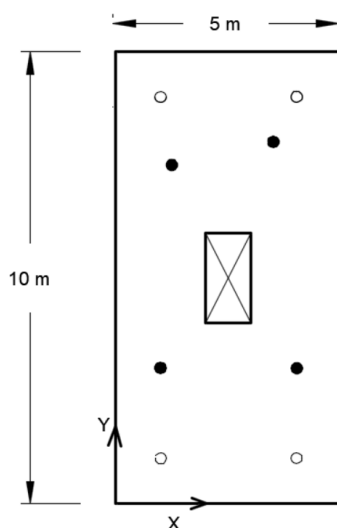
Sistema de coordenadas da laje com furo e posições iniciais e finais dos 4 pilares.
